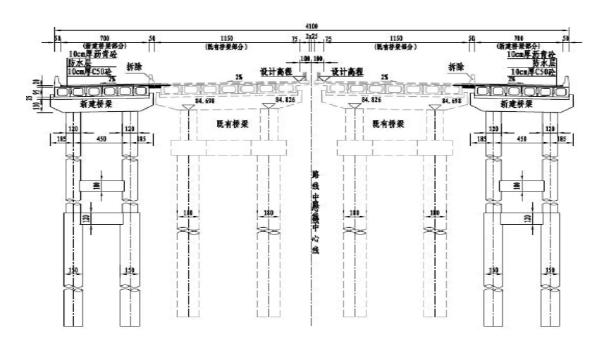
杨林水库大桥断面图 (两侧为新建桥梁,中间为老桥部分断面)
